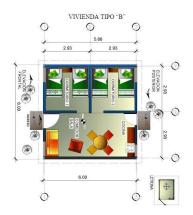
Plano de planta vivienda tipo Fopavi. Fotografía de http://www.google.com.gt 2015
